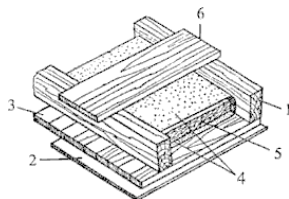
Чердачное перекрытие: 1 – балки; 2 – подшивка потолка; 3 – настил из необрезных досок; 4 – пергамин; 5 – утеплитель (минераловатные плиты); 6 – ходовая доска.
